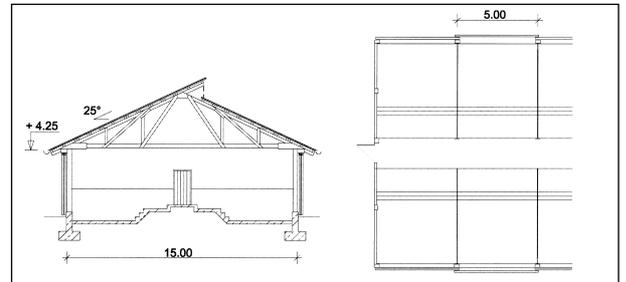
Schnitt und Grundriss von Mastschweinen auf Tiefstreu
